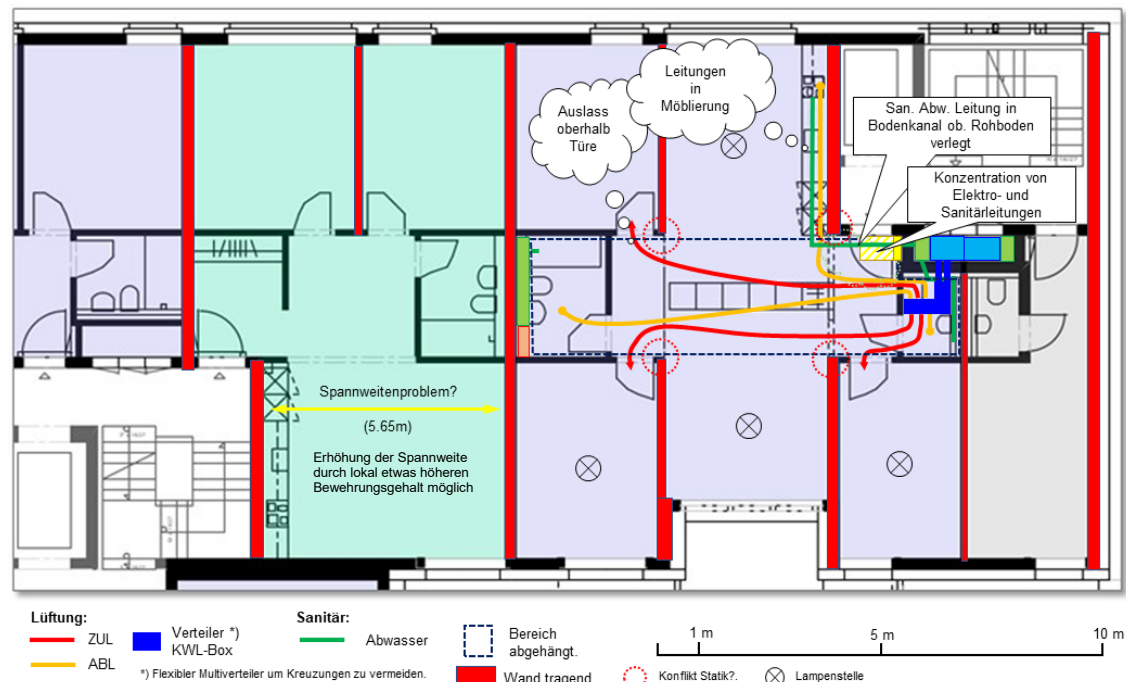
schematischer Grundriss zur Variante 2 «Abgehängte Decke, Betondecke nach Schall Mindestanforderungen dimensioniert»
